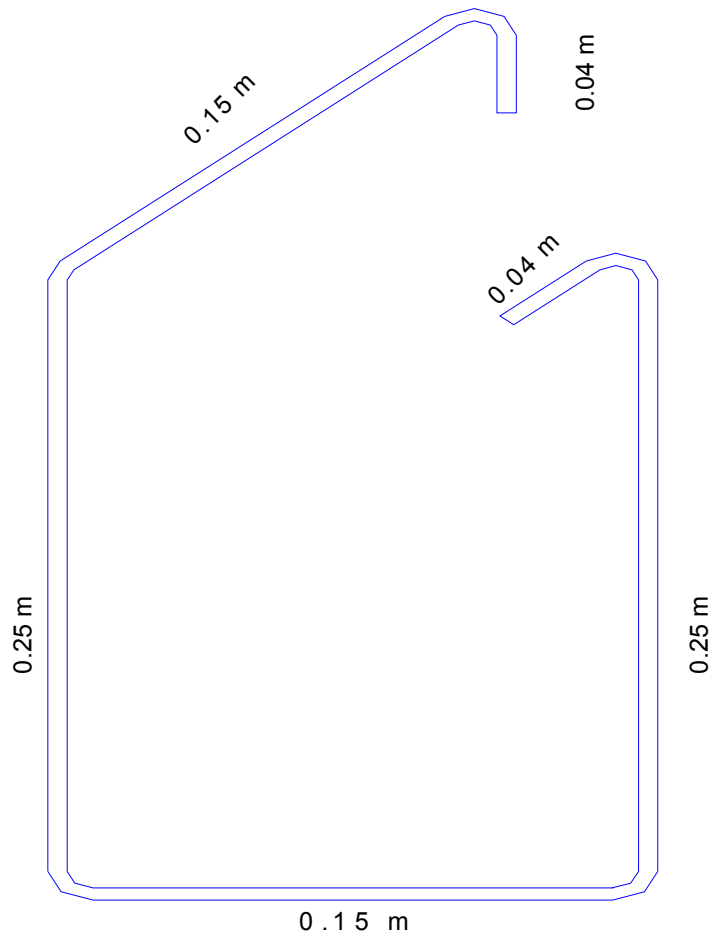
Sección Transversal en el centro de la luz y en los apoyos de la viga de carga para el modelo reducido escala 1:2
